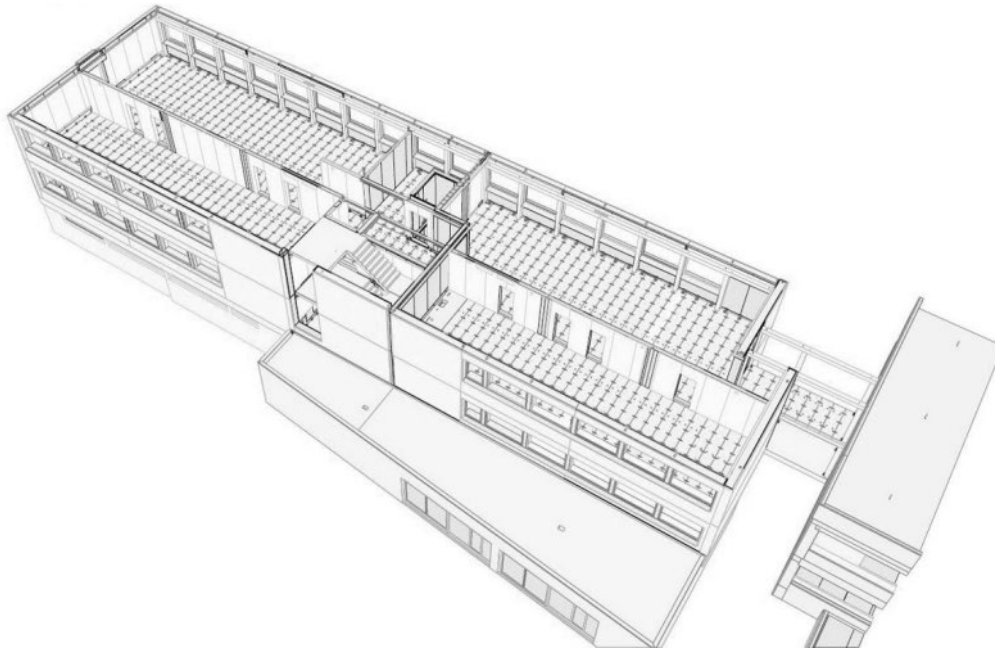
Konstruktion (©müllerblastein Holzbauwerke)
